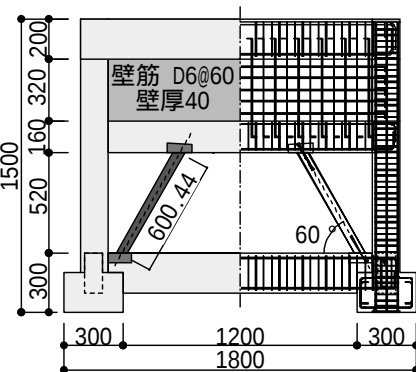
架構試験体の形状と配筋および寸法(単位: mm)
